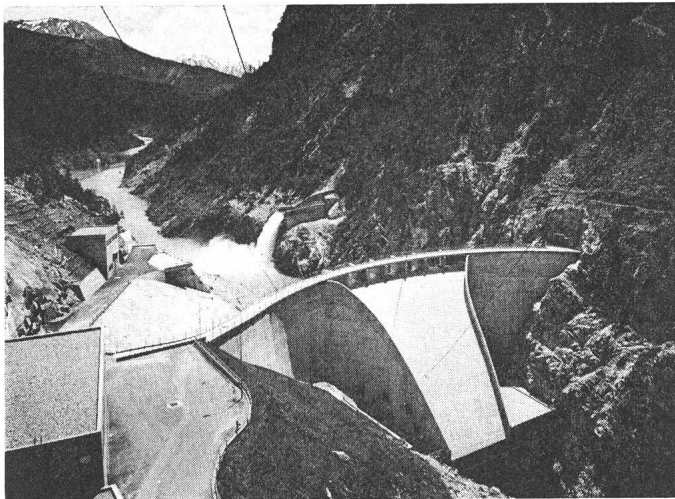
Staumauer und Maschinenhaus Ova Spin
